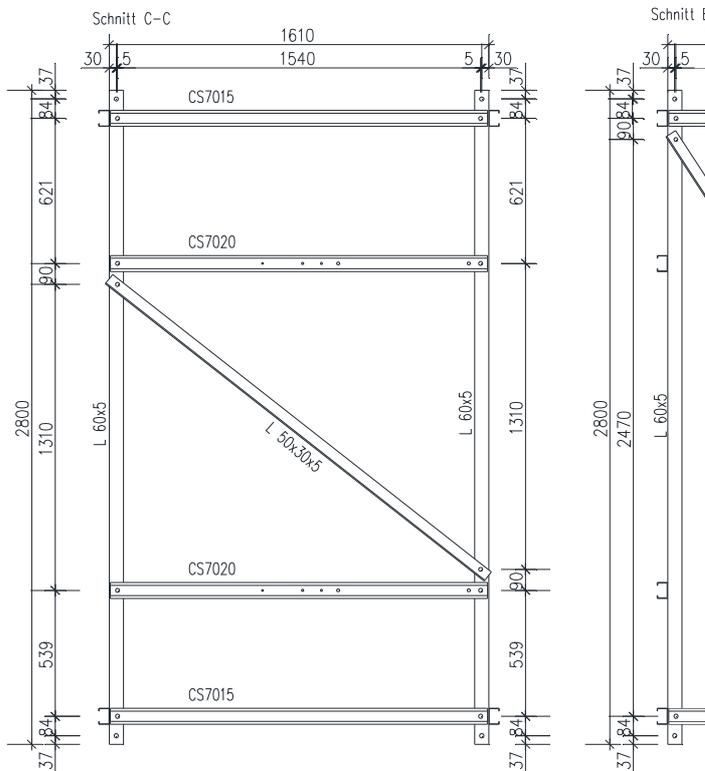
Seitenteil mit Querträger für Einbauteile / wall element with traverse for appurtenances
